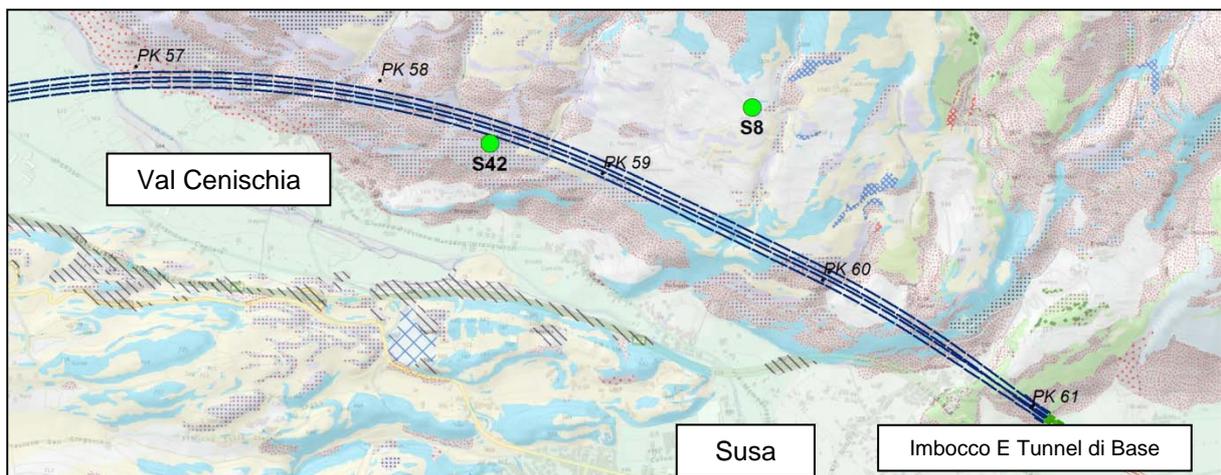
Lato Italia (settore di Mompantero): ubicazione planimetrica dei sondaggi S8 e S42 (punti in verde) rispetto al tracciato del Tunnel di Base (linee blu e viola).
